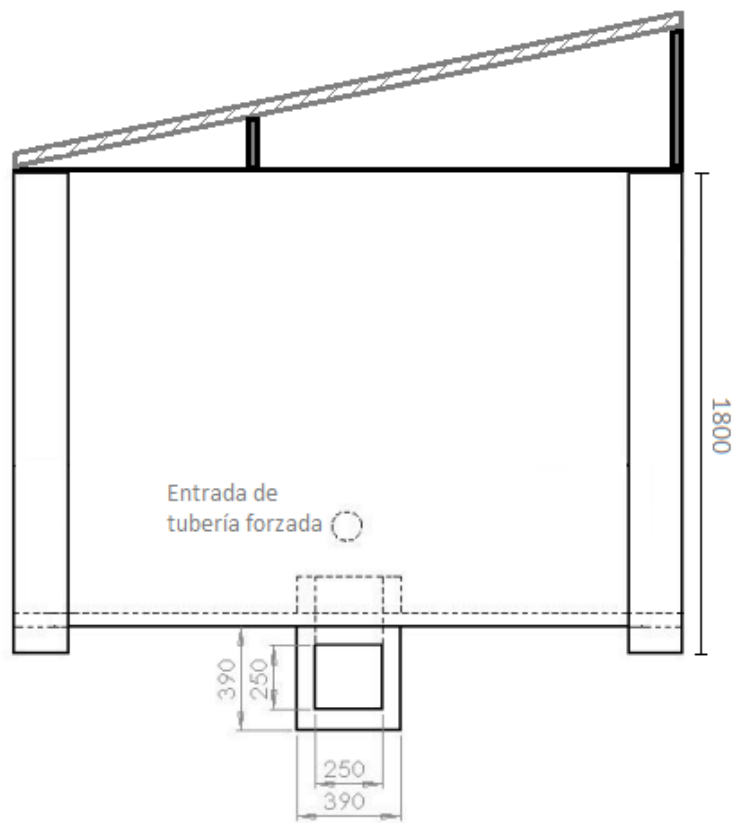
Plano de la casa de máquinas y canal de descarga. [Perfil]. Fuente propia
